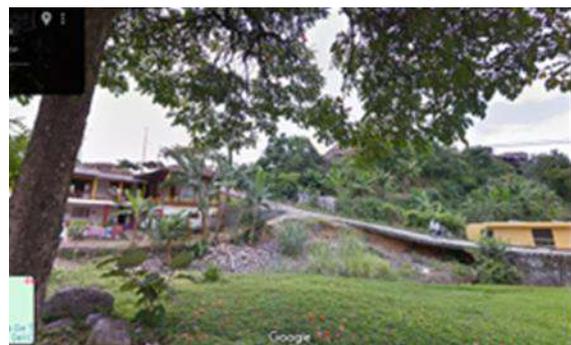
Socavación bajo la calzada hasta el inicio del puente. Fuente: Google Street view. 2024
